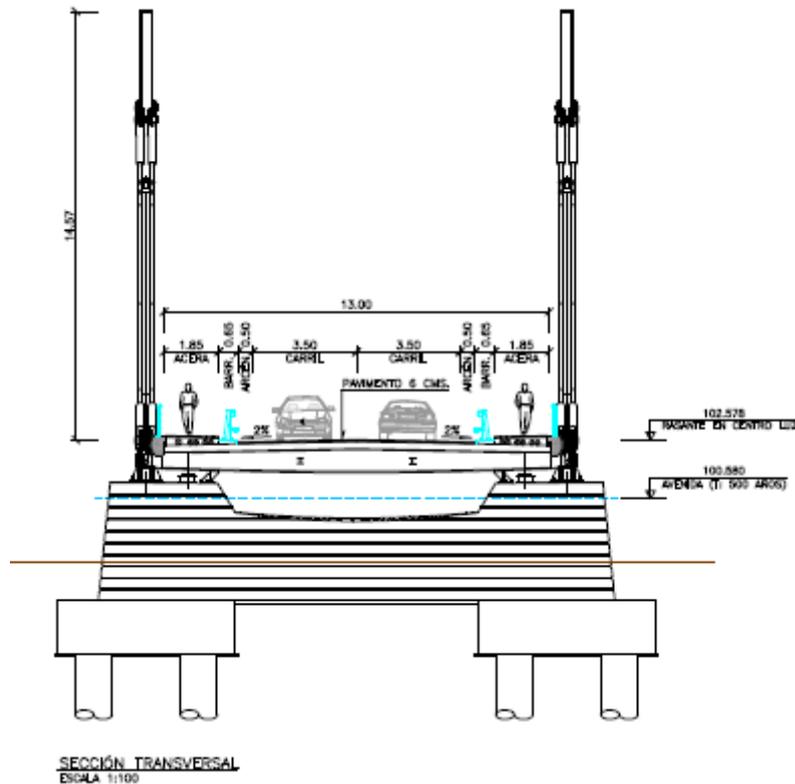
Sección transversal del Puente en Virgen de la Peña
